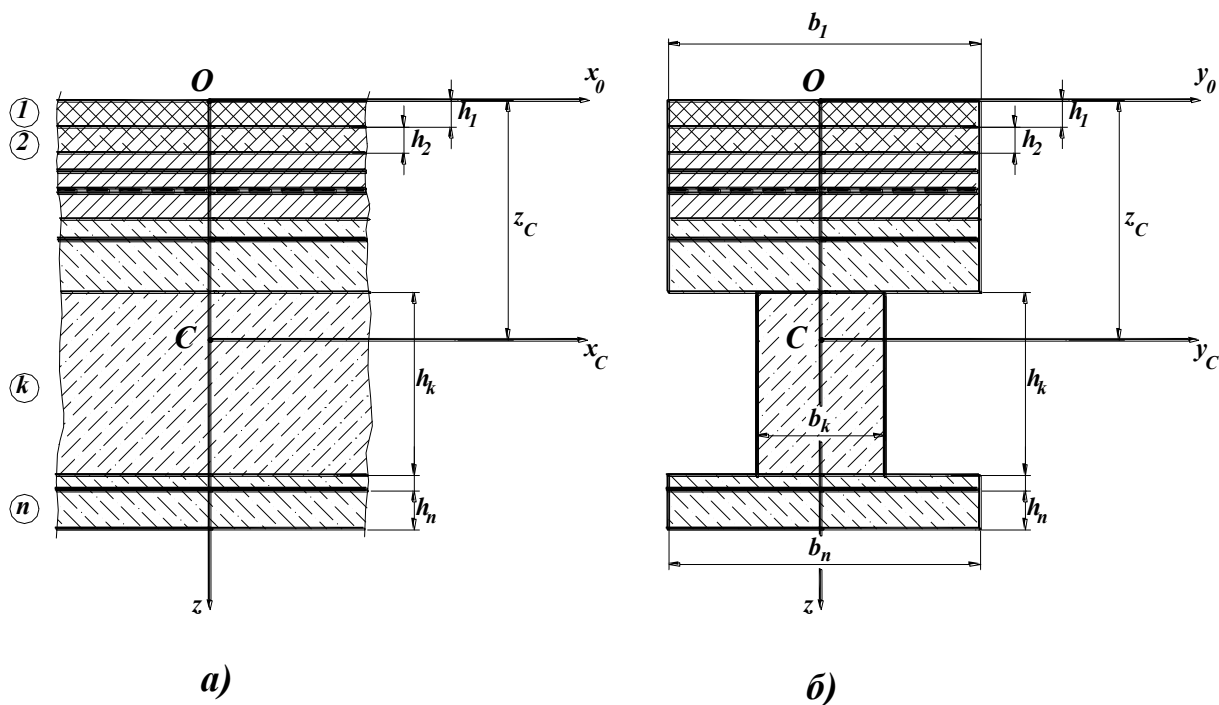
Схема пакету шаруватих конструкцій
